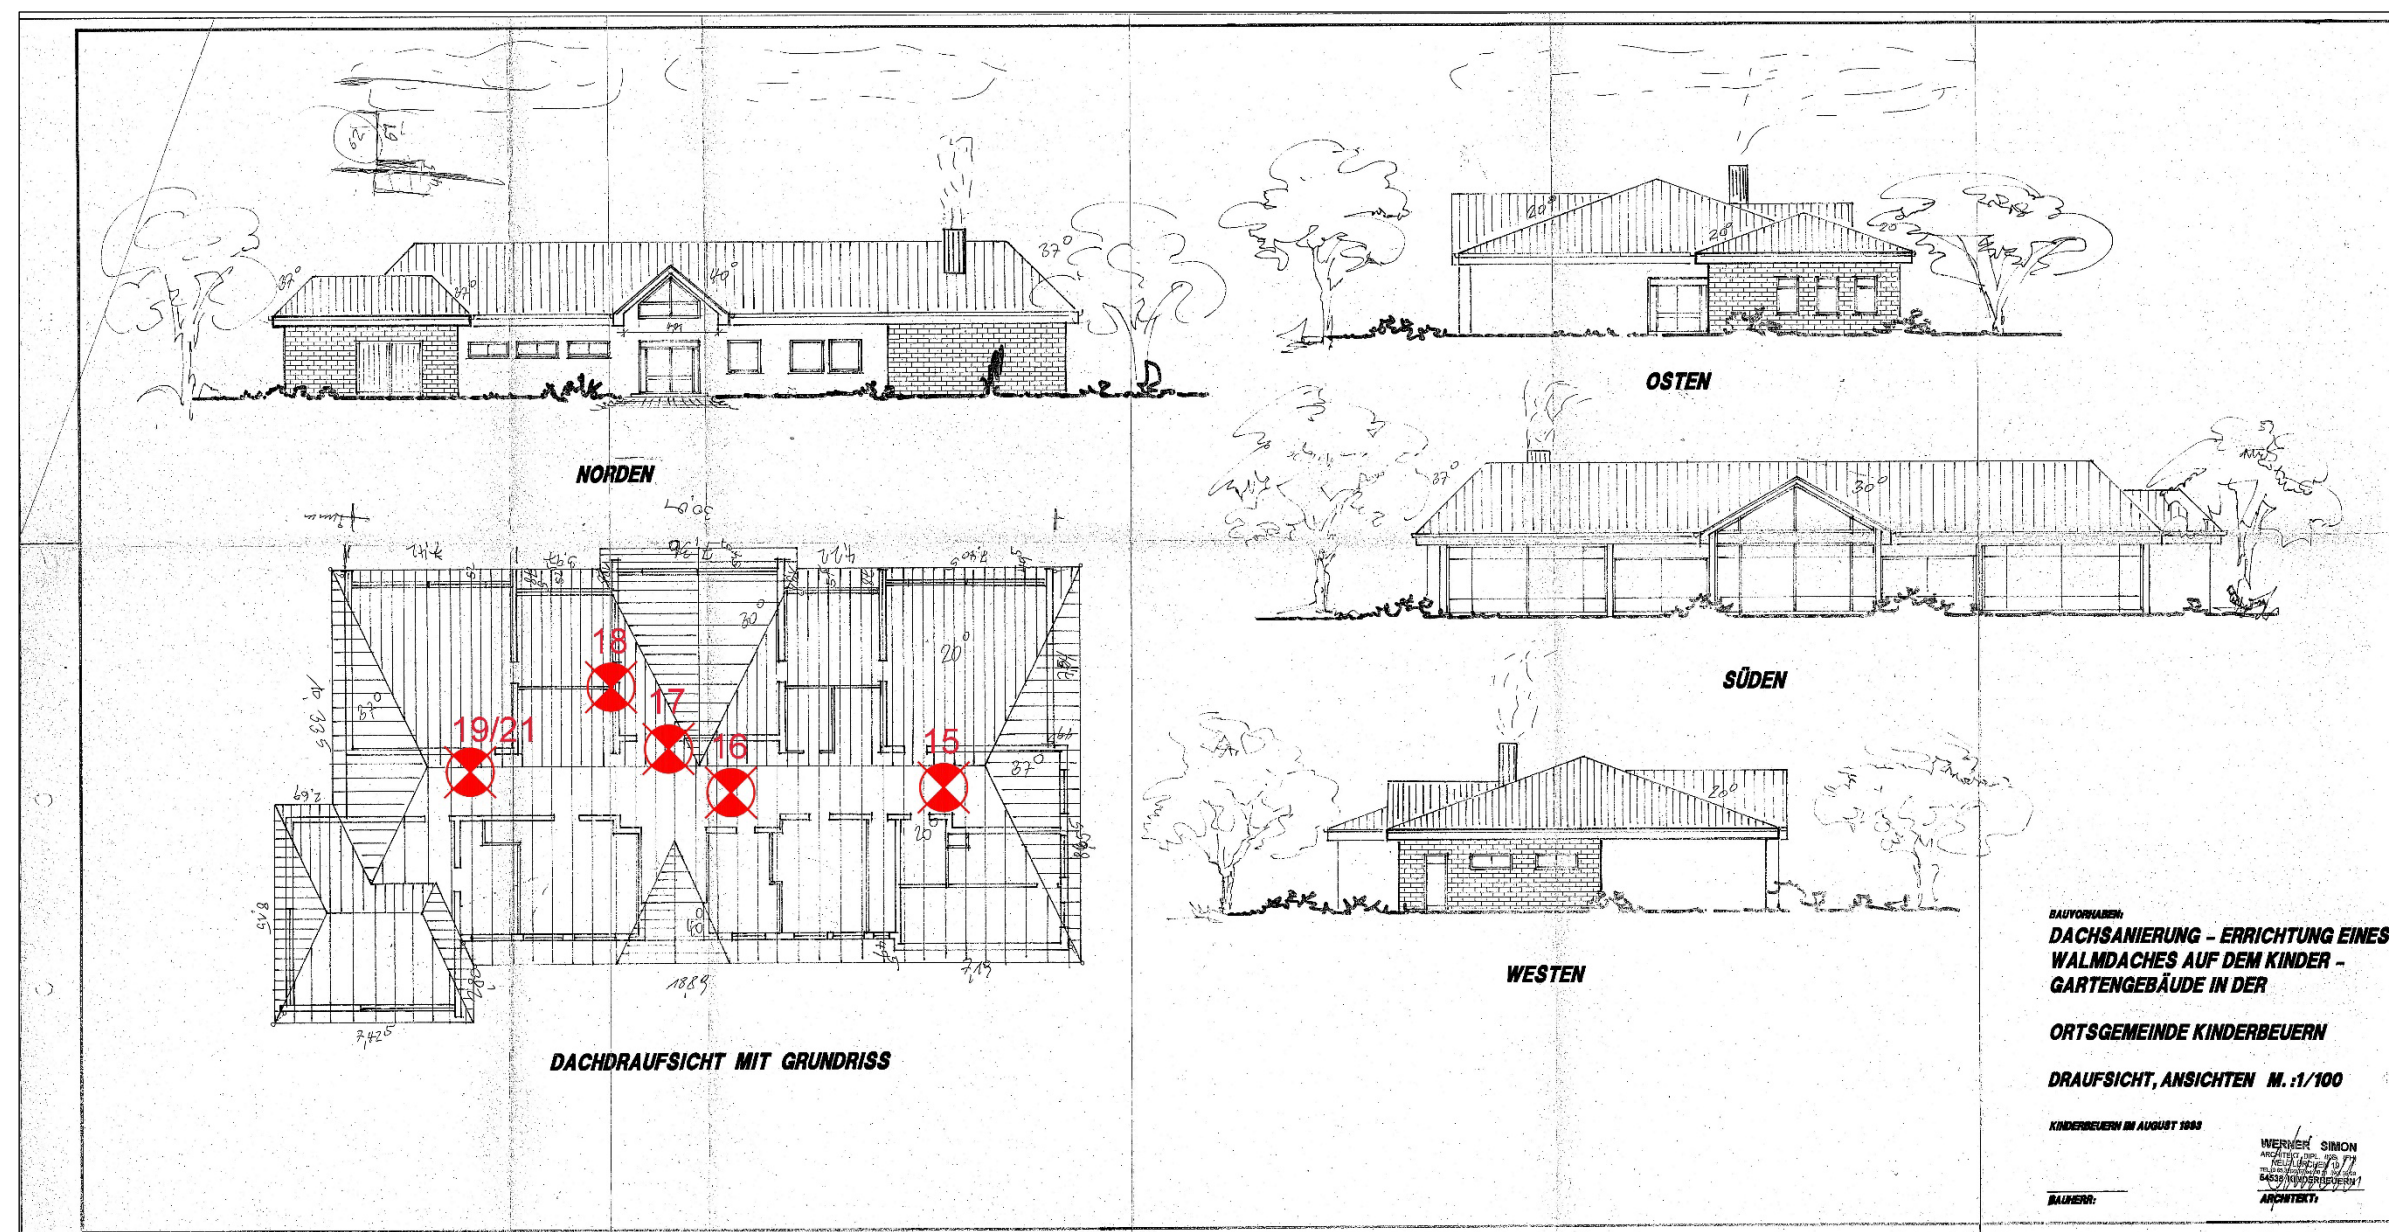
Bestandsplan mit Probenahmestellen (Dachgeschoss) – ohne Maßstab
